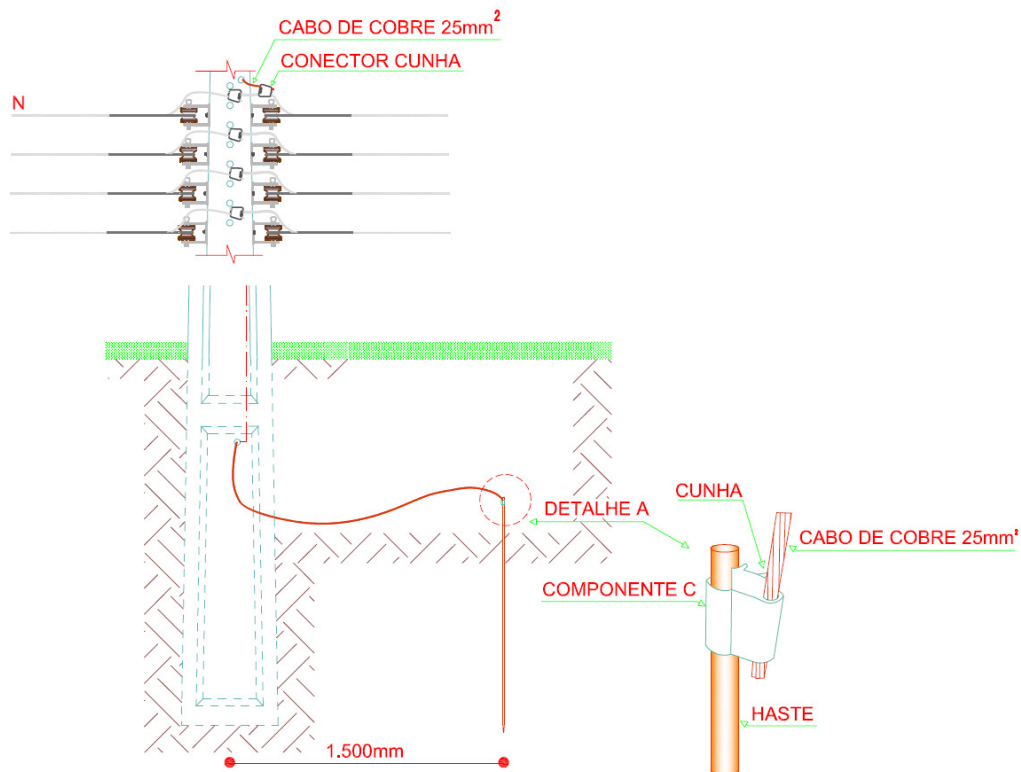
Aterramento de Rede Secundária em Estrutura de Seccionamento ou Fim de Linha
